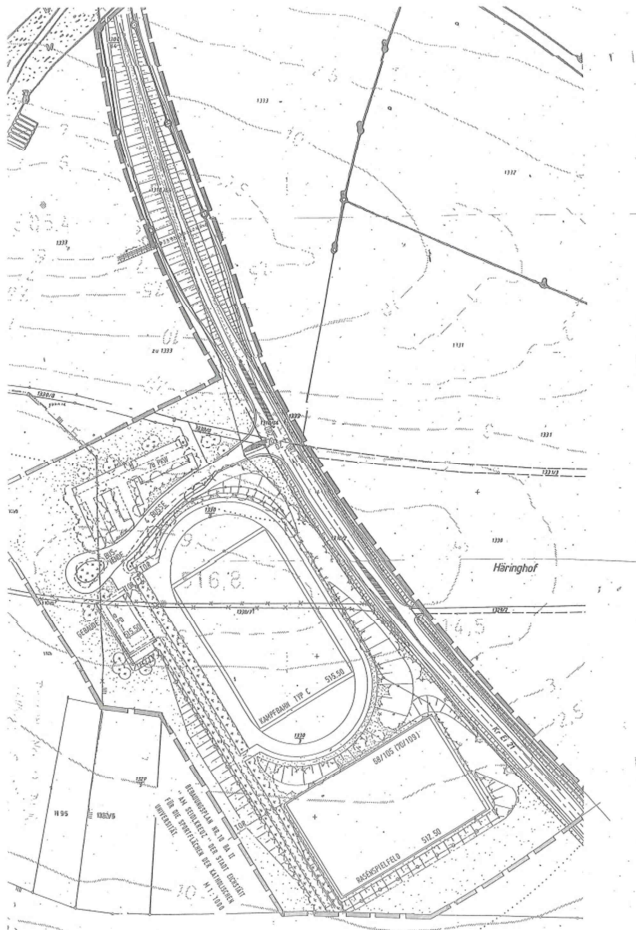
Quelle: Stadt Eichstätt, Stadtbauamt
